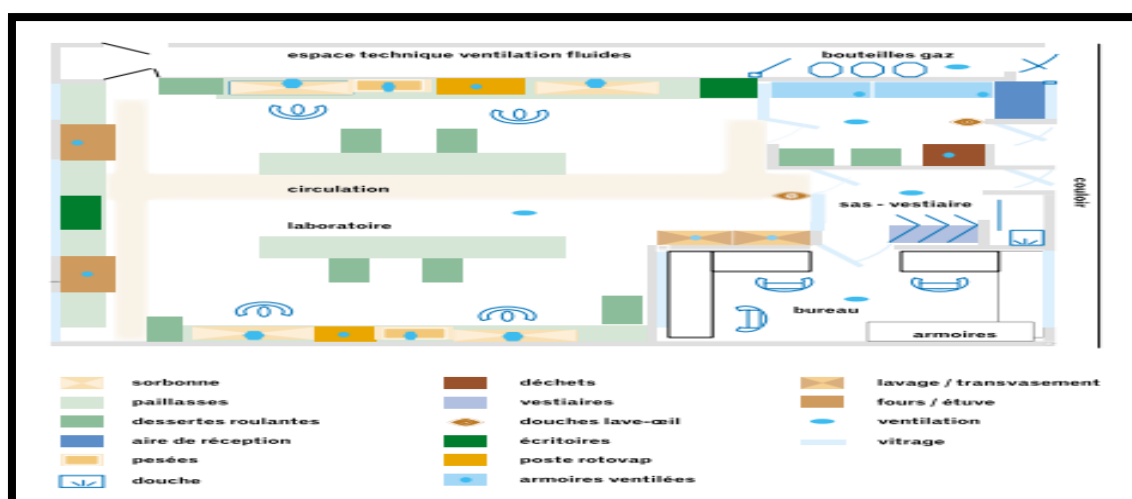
Exemple de plan d'un laboratoire ⁸¹
